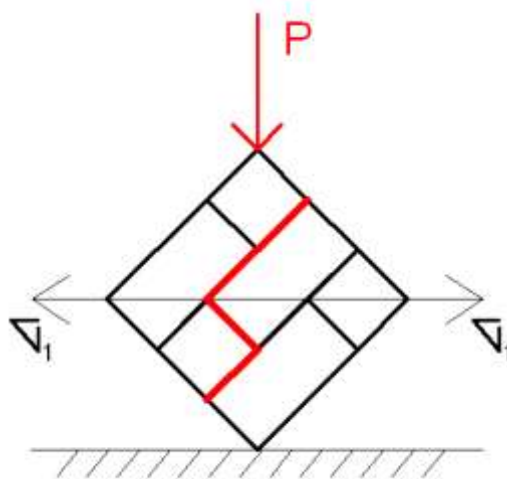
Zona de falla en muretes con juntas de mortero
